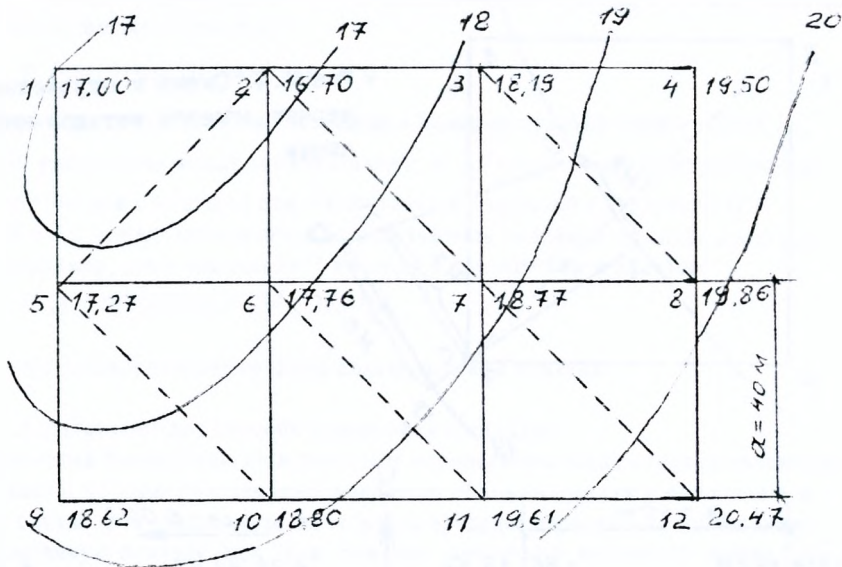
Схема разбивки строительной площадки на квадраты и треугольники (пунктиром)
